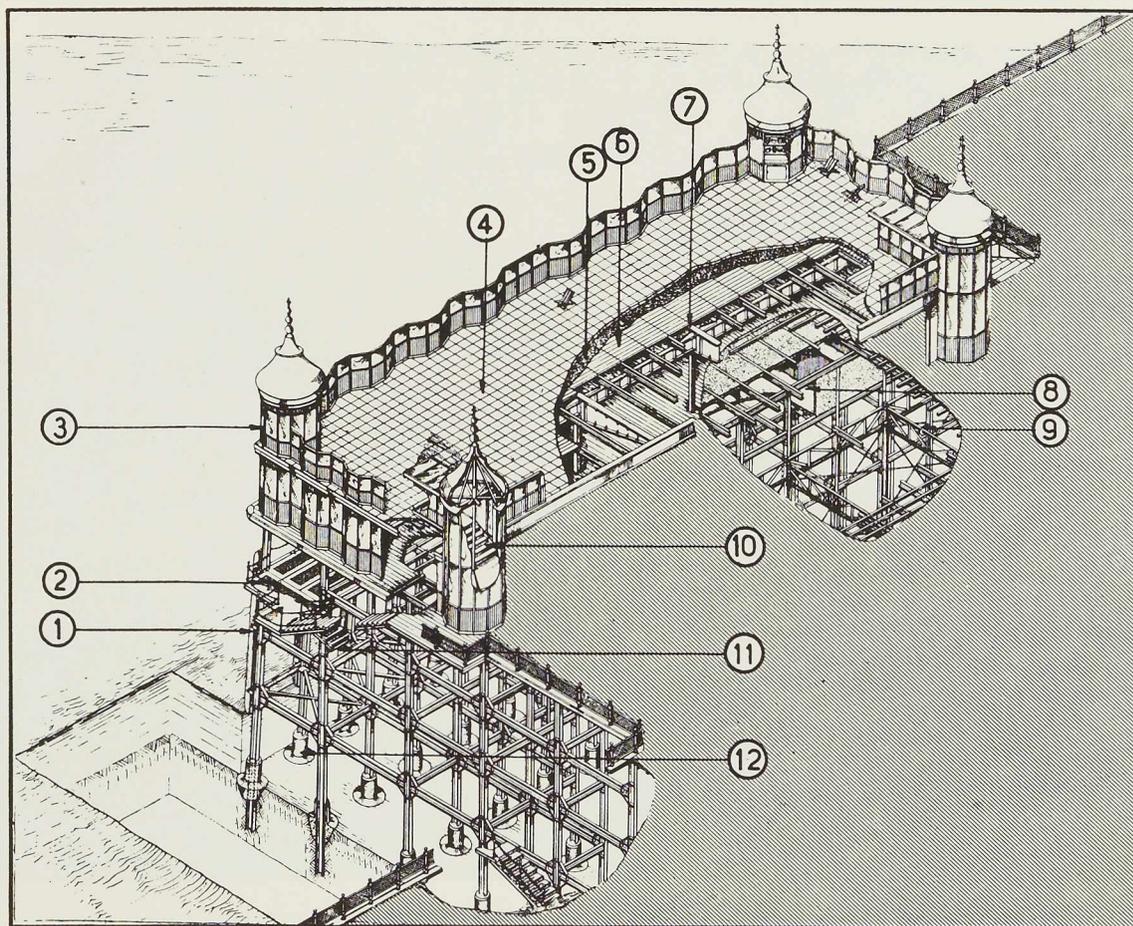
Vue partielle du pier de Brighton avec le pavillon « Palace Pier ».
